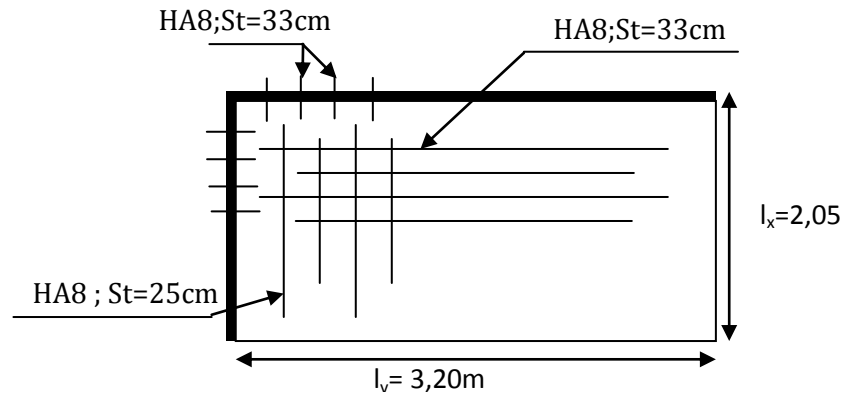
Schéma de ferrailage de la dalle pleine sur deux appuis
